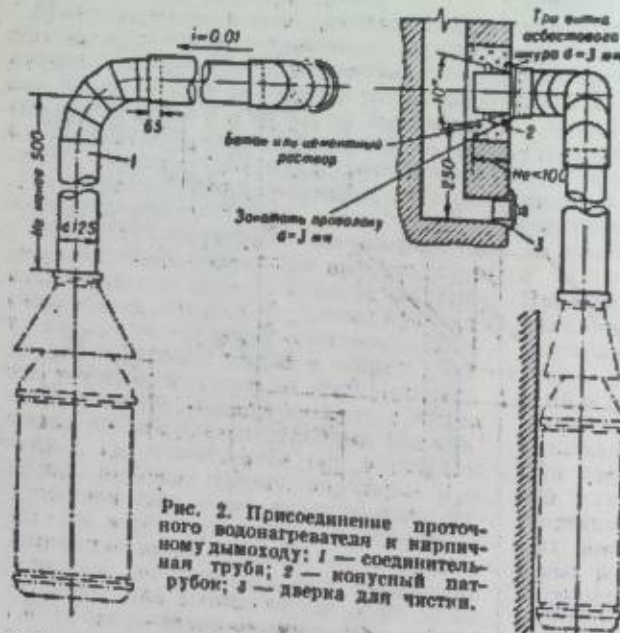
Присоединение проточного водонагревателя к кирпичному дымоходу: 1 — соединительная труба; 2 — конусный патрубок; 3 — дверца для чистки.
